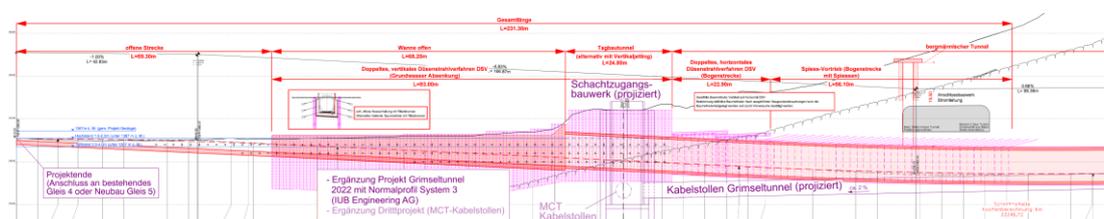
Längenprofil Einfahrt Oberwald (Plan SPI mit Ergänzungen aufgrund System 3)
